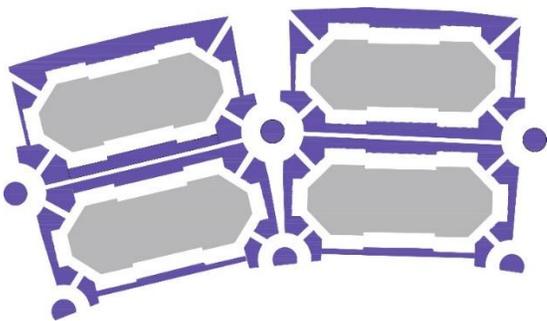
Equipamiento Lo Ermita. Fuente: Elaboración propia
